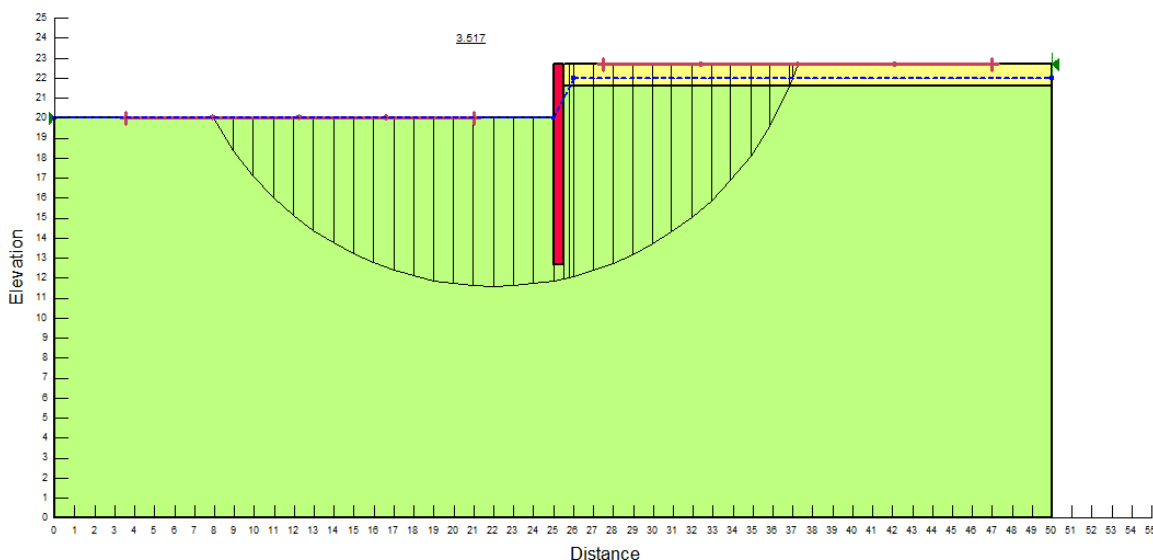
Verifica stabilità globale _ spalla SP1
